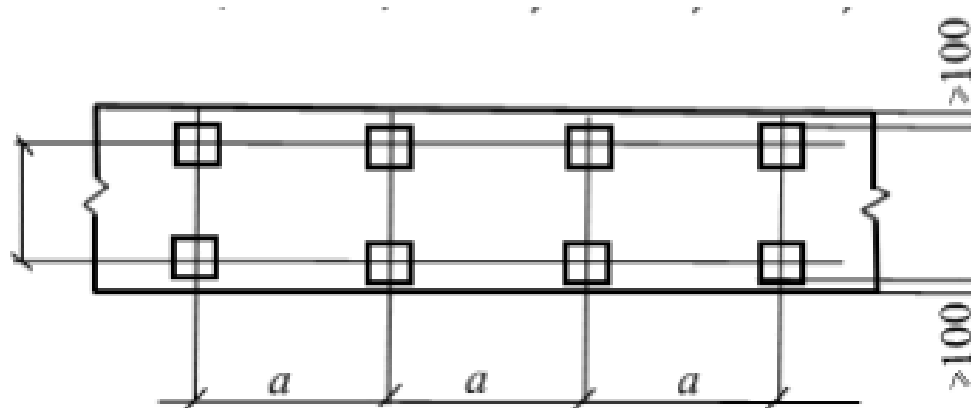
Схема расположения свай в рядовом фундаменте
